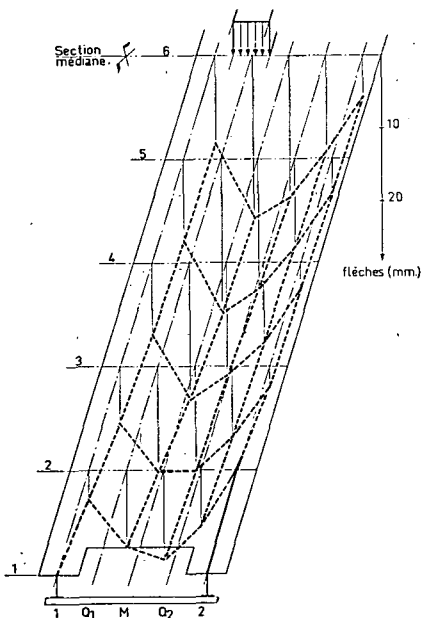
Déformée d'une travée à 2 poutres sans entretoise.
